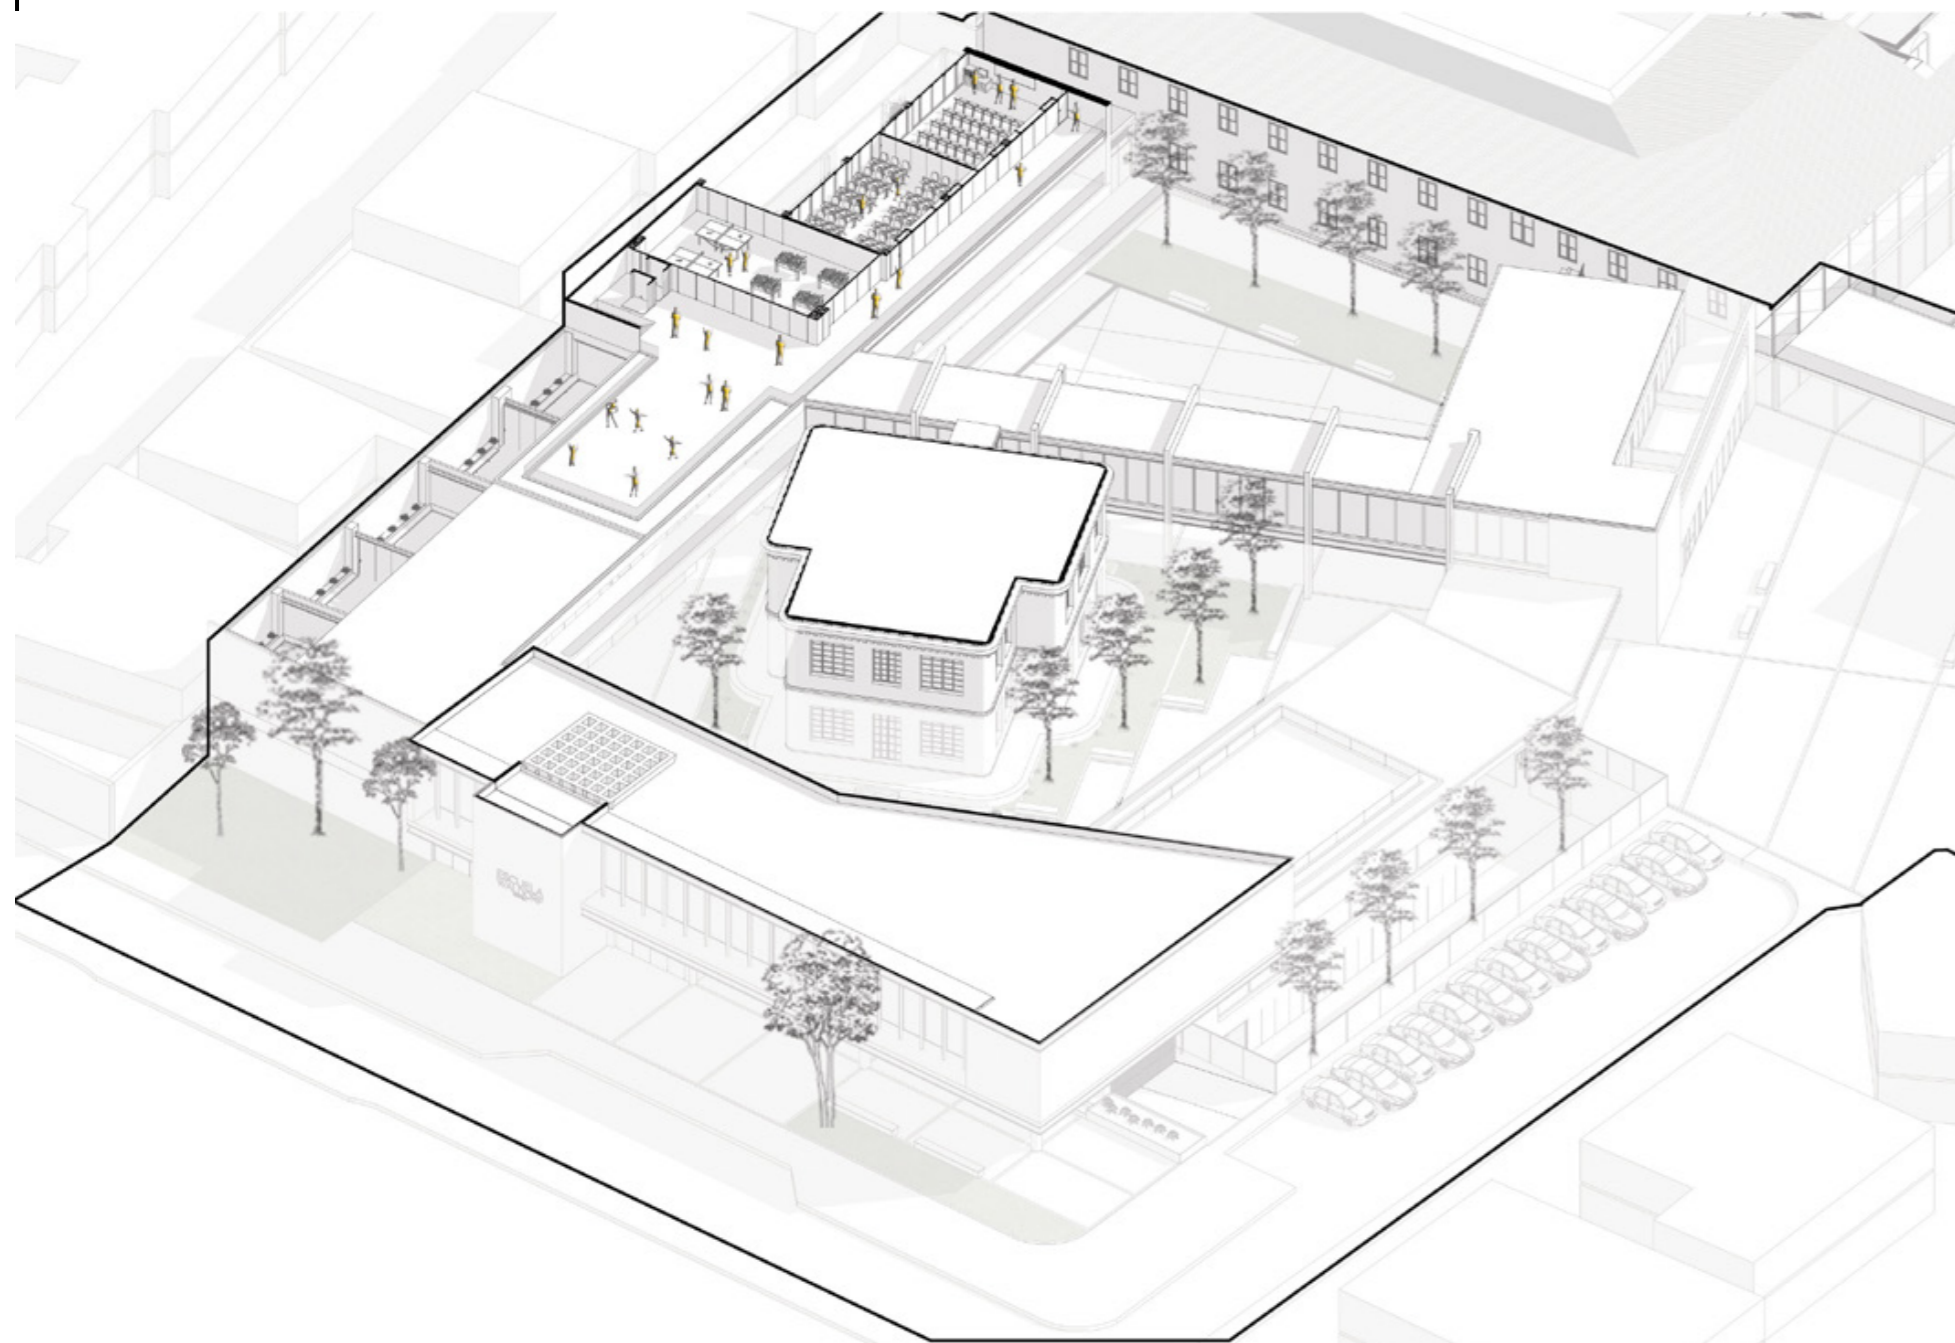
Axonometría 1ra Planta Alta | Fuente: Elaboración propia
